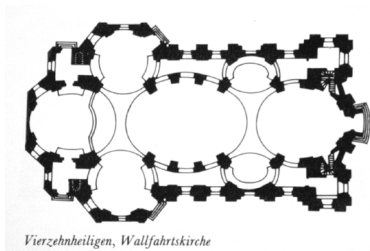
Vierzehnheiligen Wallfahrtskirche, Grundriss, J. B. Neumann, 1743 -1772
